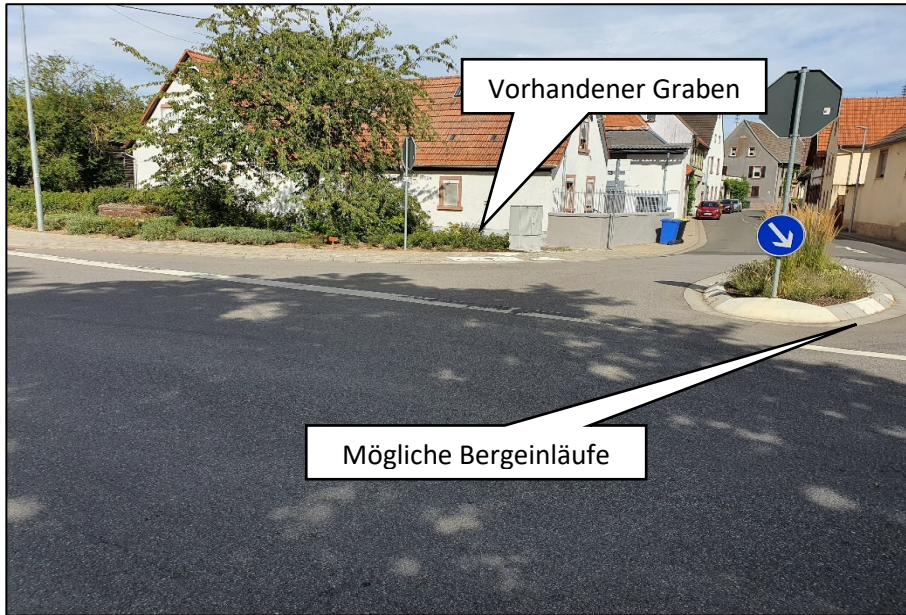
Schlosshohlstraße – Kreuzung Alzeyer Straße
